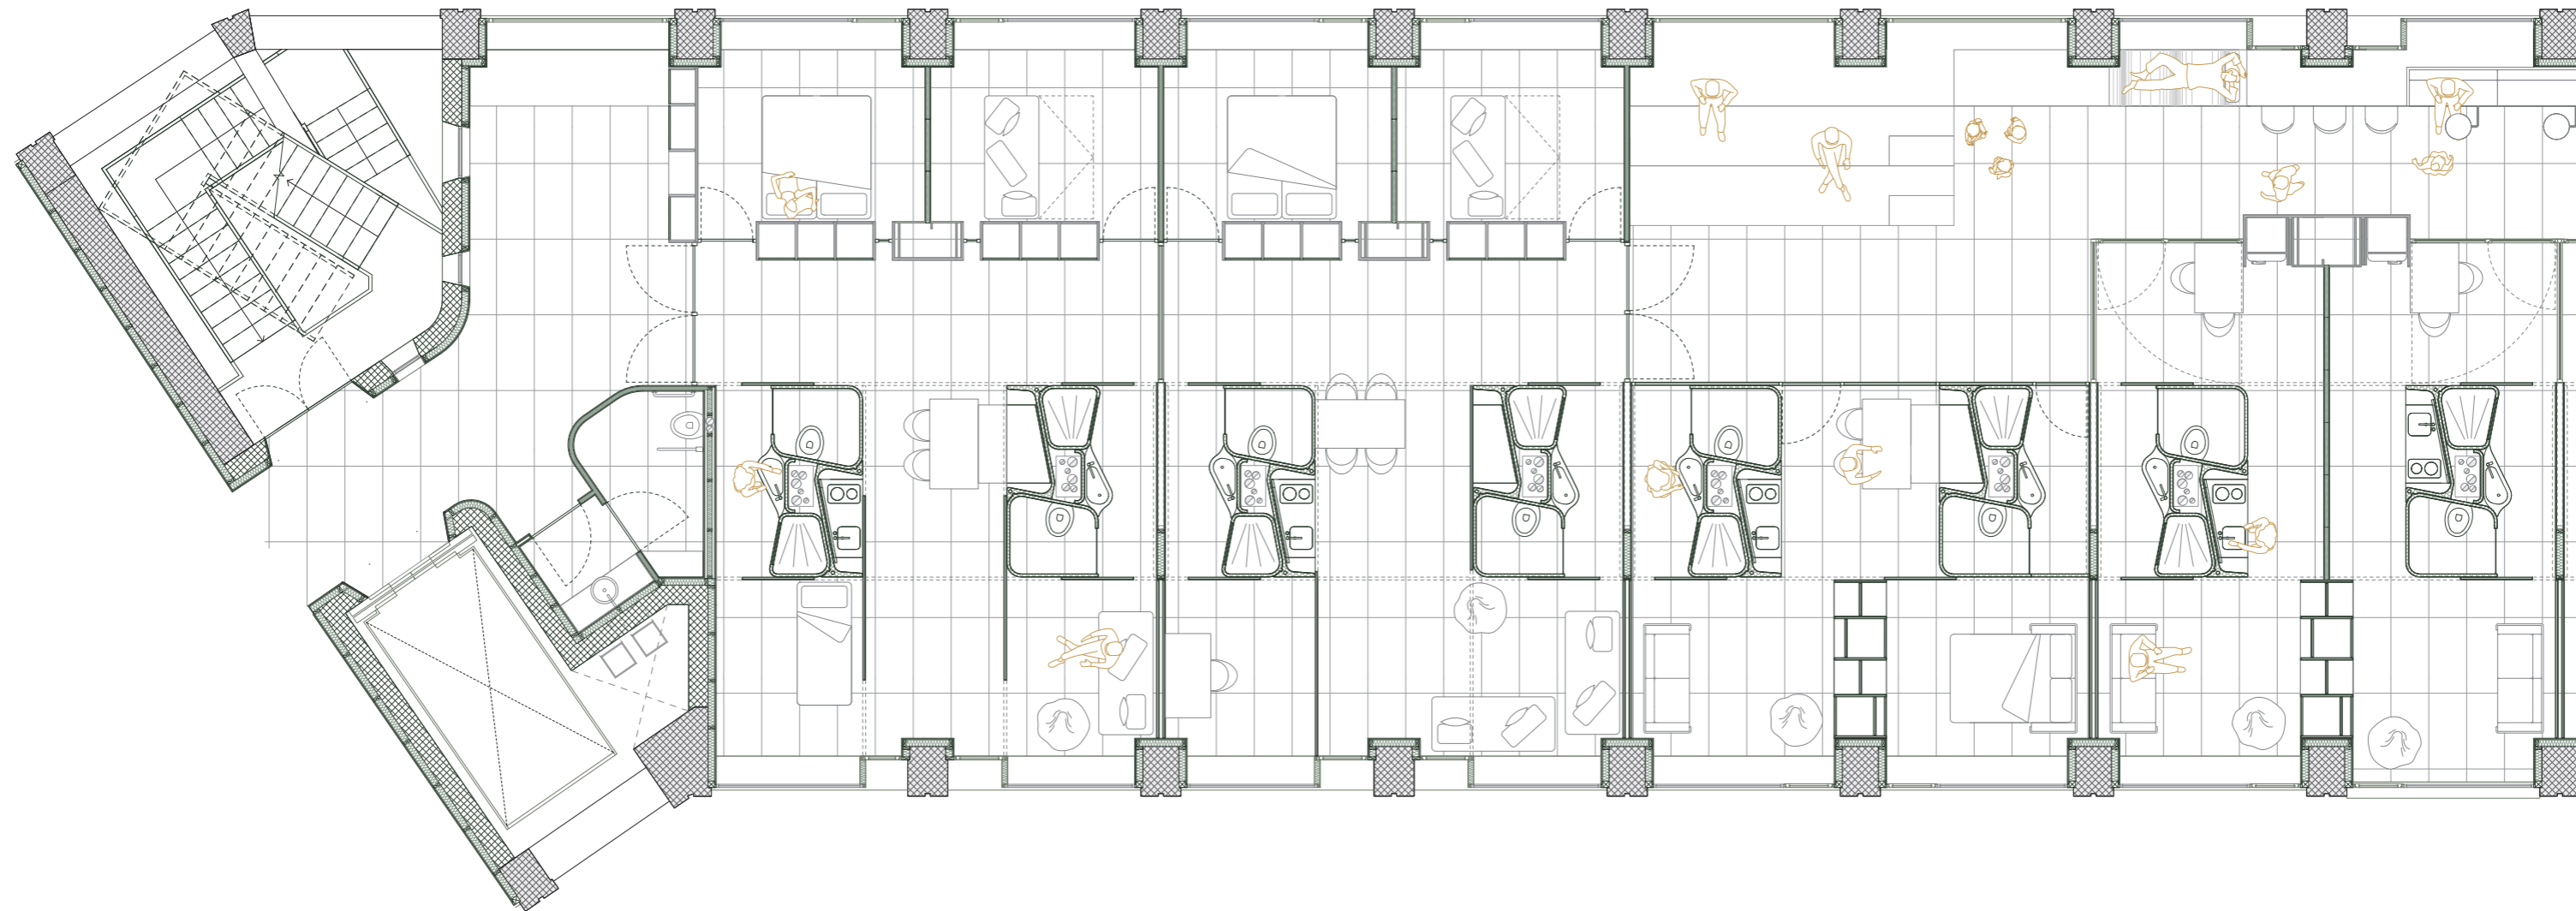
Estratto pianta piano tipo- bassa densità.
